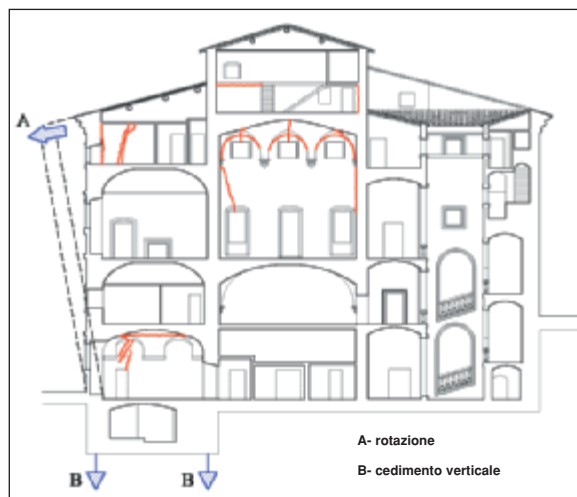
Sezione mediana Est-Ovest, rotazione della parete perimetrale Est e cedimento verticale.
